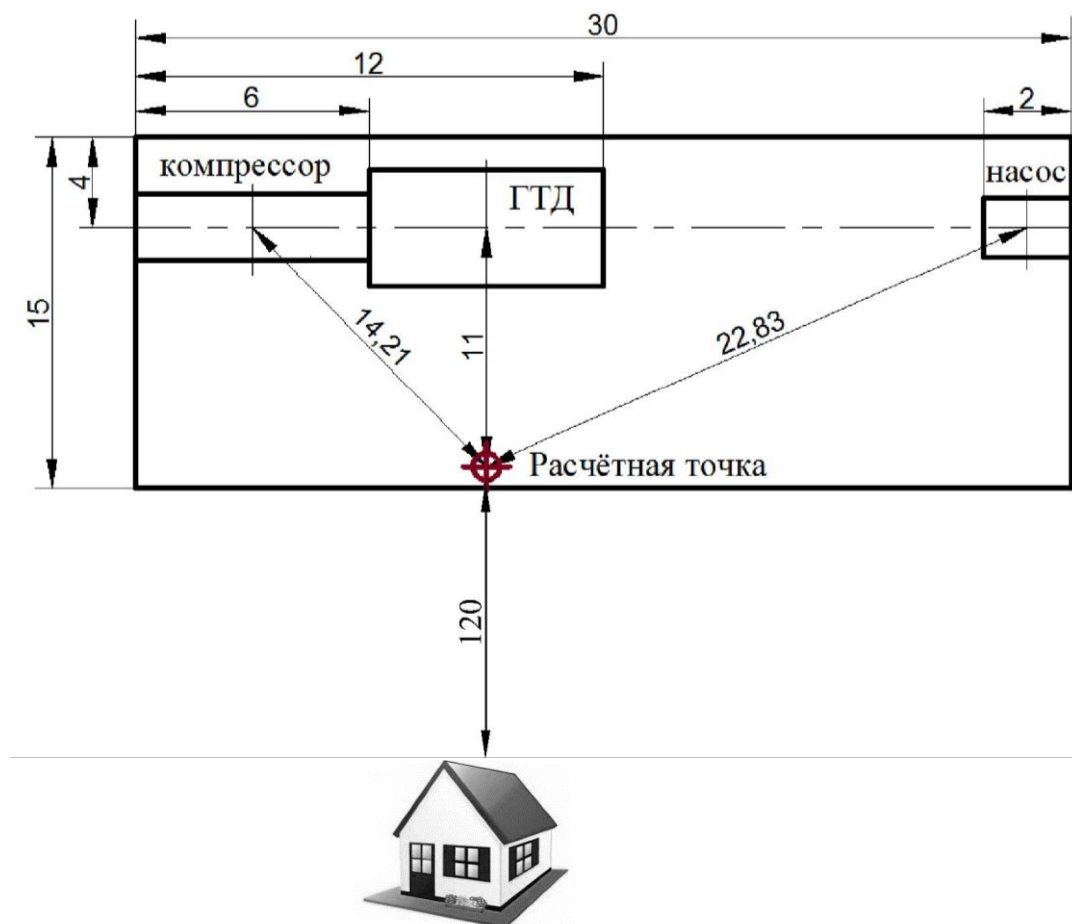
Планировка помещения с размещением оборудования и жилой дом, расположенный на границе санитарной зоны
